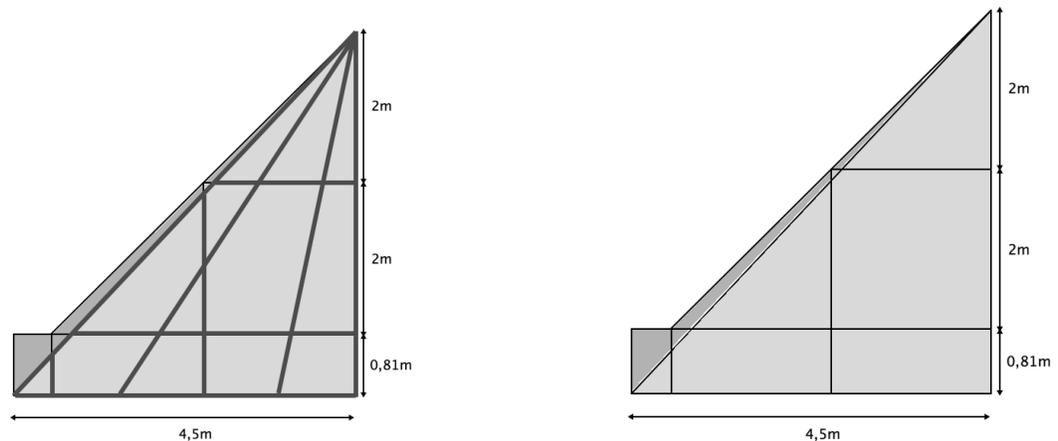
Paneles Techo lateral estructura (izq.) y vista externa (der)
